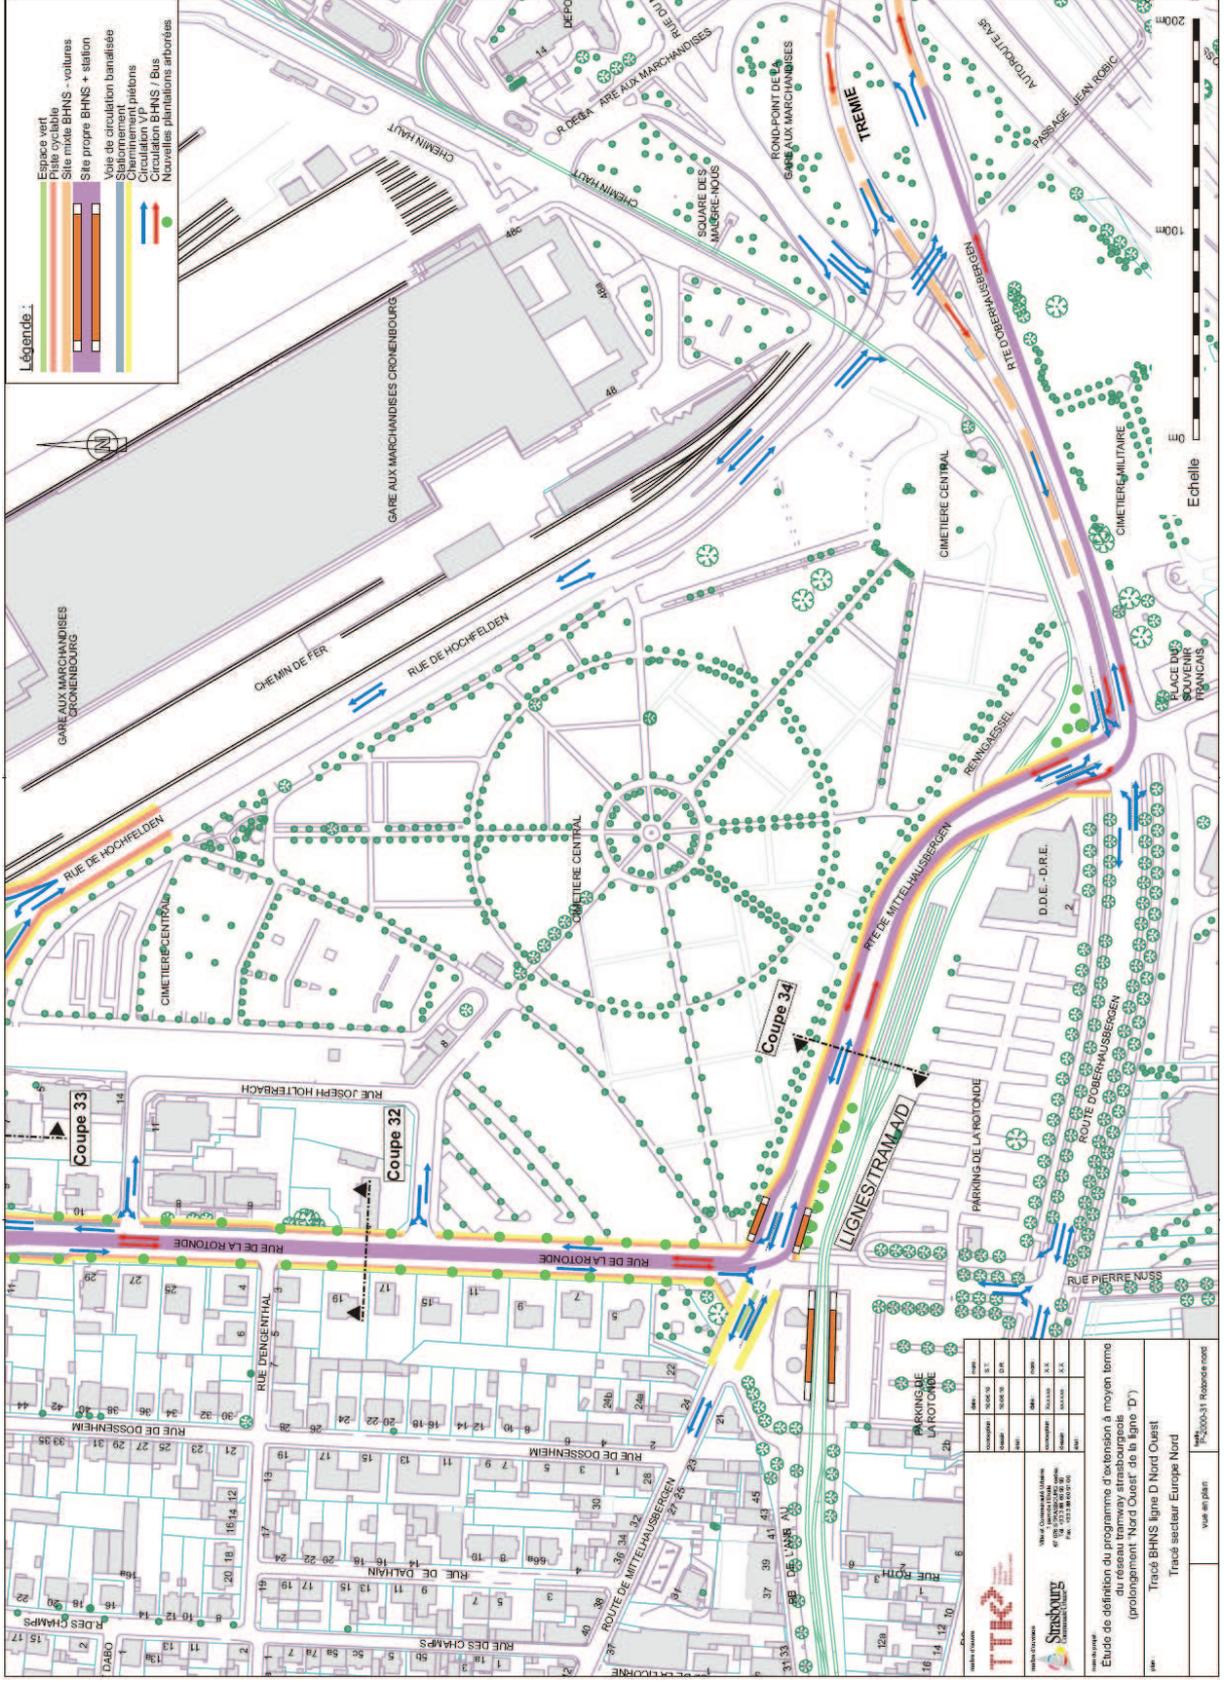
Plan d'insertion du secteur "Rotonde Nord" (échelle 1/2500^{ème})
